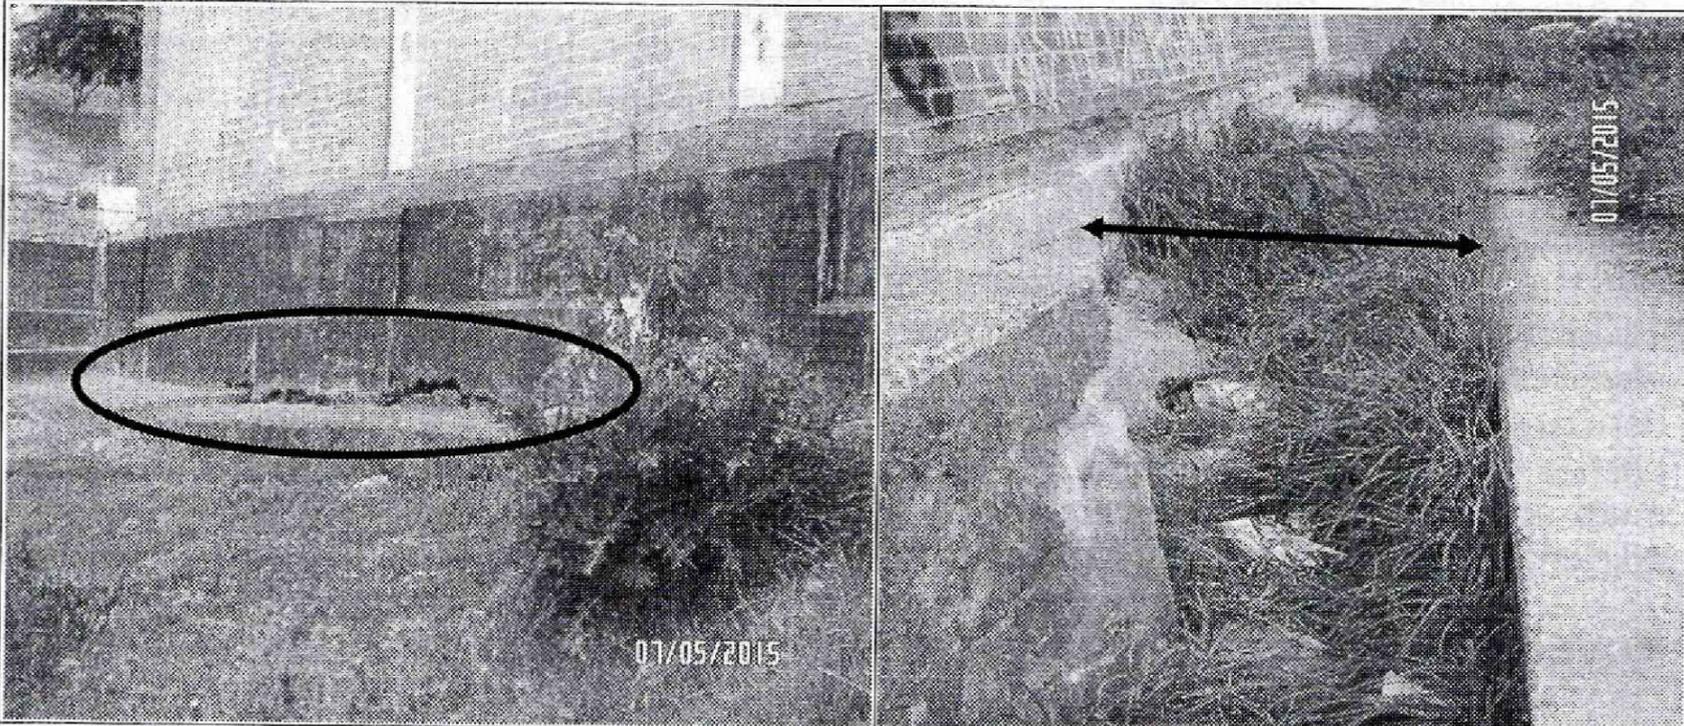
Se observado el Colegio los Pinos, edificación de tres (3) niveles, construida bajo un sistema estructural de pórticos en concreto, placa de entepiso en concreto y cubierta en teja de fibrocemento, en donde no se identificaron afectaciones tipo grietas, fisuras o pérdida de verticalidad en los elementos estructurales y de cerramiento que comprometan su estabilidad y funcionalidad
